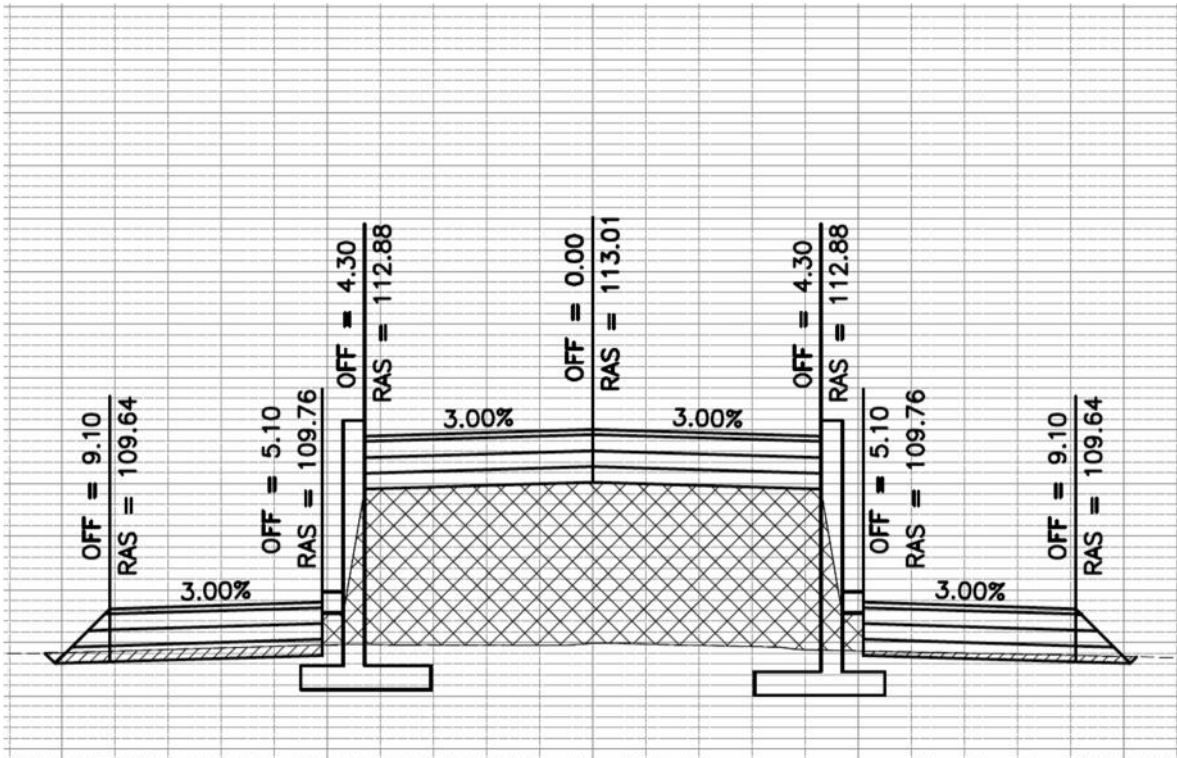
DERECHO DE VÍA Y SECCIONES TRANSVERSALES EXISTENTE (TIPO) Y DE PROYECTO DE LA CARRETERA ESTATAL NO 2 EJIDO PUEBLA-CERRO PRIETO-EJIDO NUEVO LEÓN (PARA MAS DETALLES VER PLANOS DE SECCIONES TIPO).
